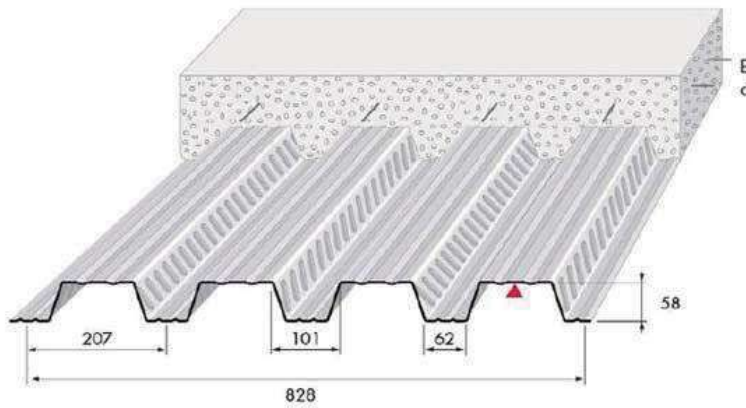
Losa a base de lámina de acero y capa de compresión a base de concreto armado.
